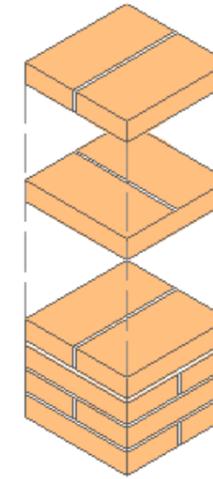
Detalle aparejo pilar. Fuente: autor propio
